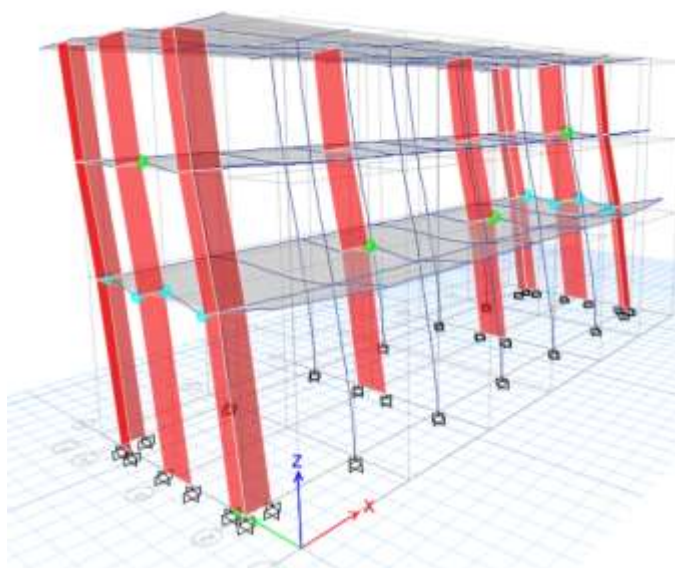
Estado de rótulas Tipo fibra dirección Y para un desplazamiento objetivo de 4.2cm
